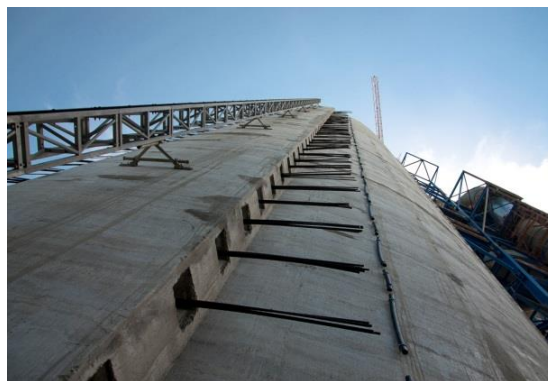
Ponte Anita Garibaldi em fase de construção em Laguna/SC, com vãos em aduelas pré-moldadas protendidas. (Fonte: Berd - Bridge Engineering Research & Design, <https://www.berd.eu/projectos/laguna>)
